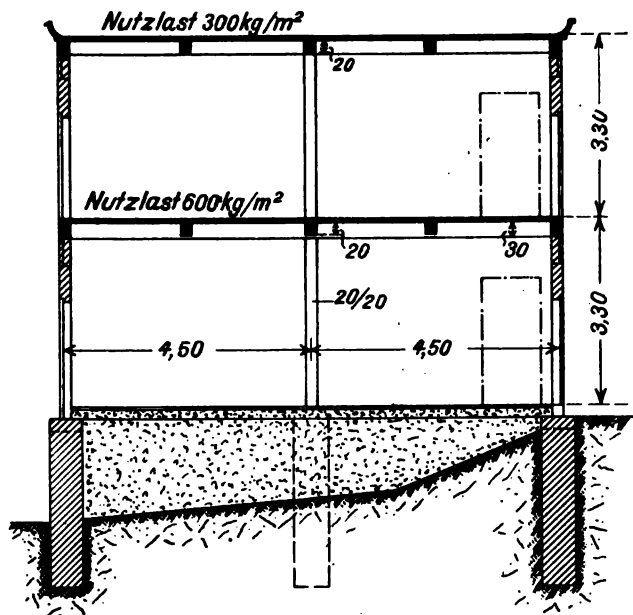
Eisenbetondach mit Pyxolinanstrich.
